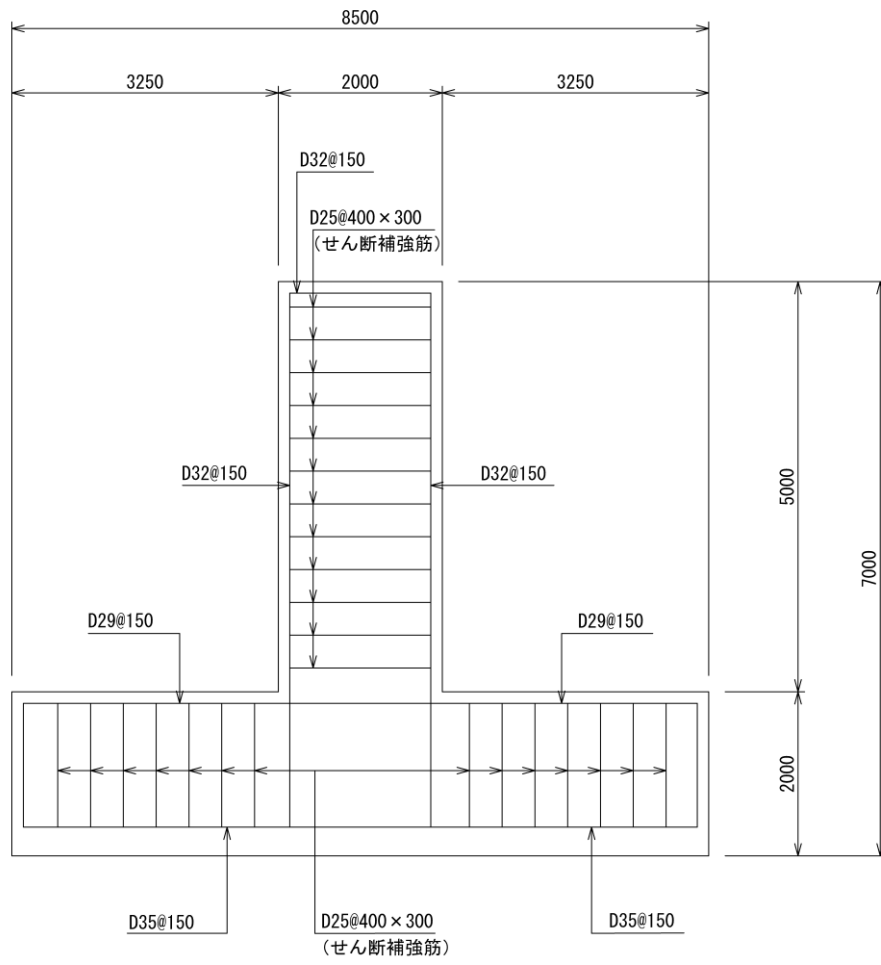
(3) 防波壁 (逆 T 擁壁) の構造図 (概略配筋図)
